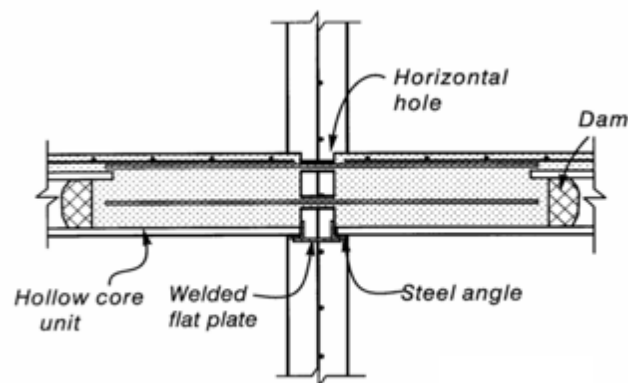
Muro dividido con unión horizontal (fib, 2003).
